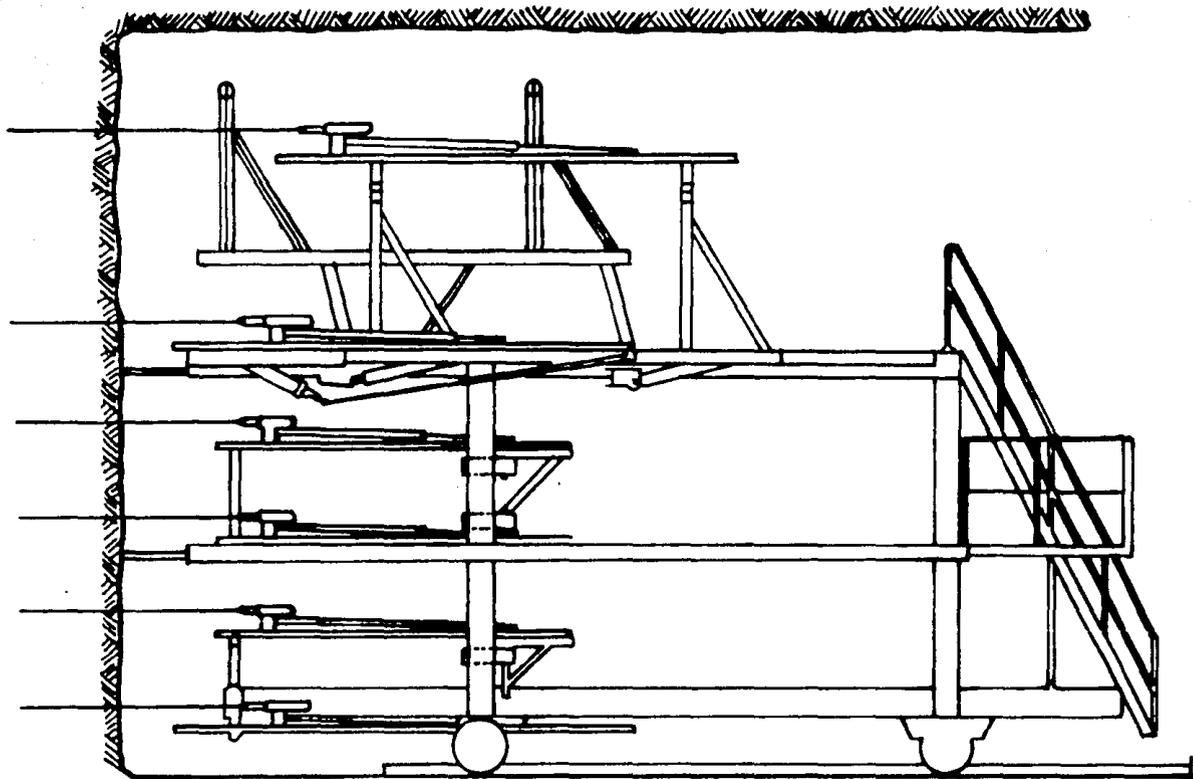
VISTA LONGITUDINAL DE JUMBO DE PORTICO
